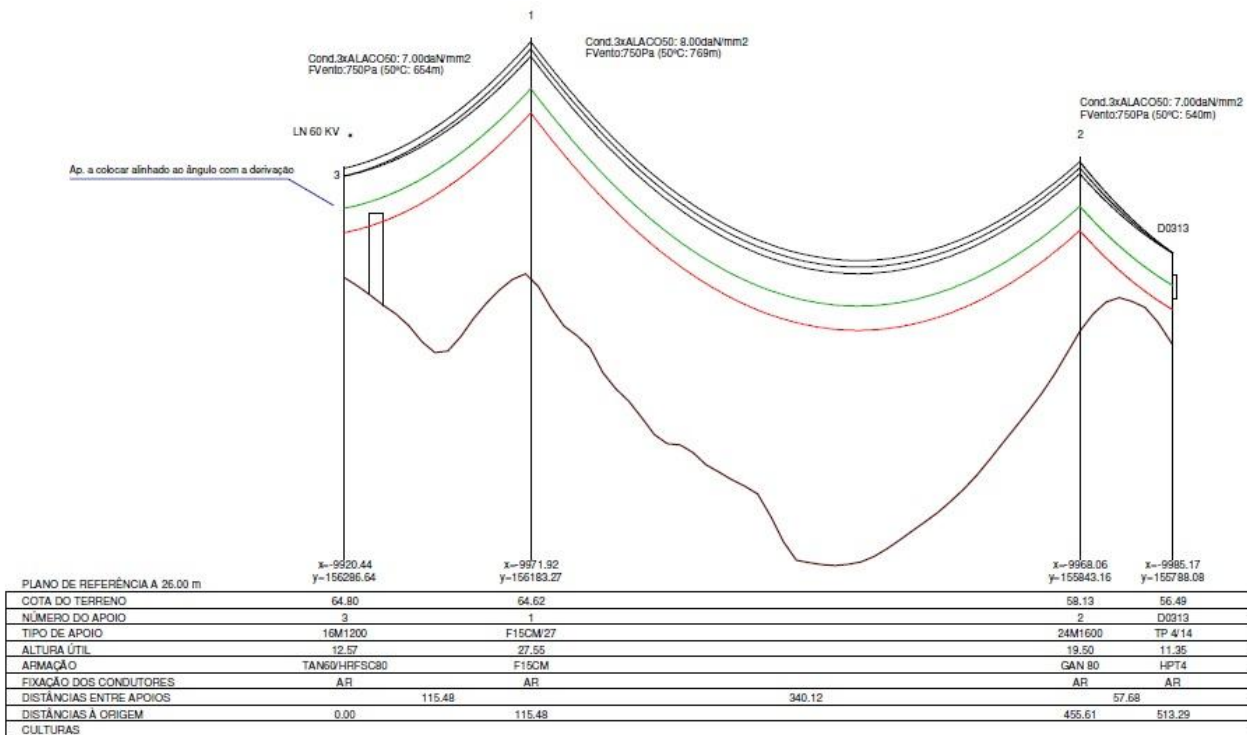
Perfil da Linha MT (Fonte SIT-DM).
